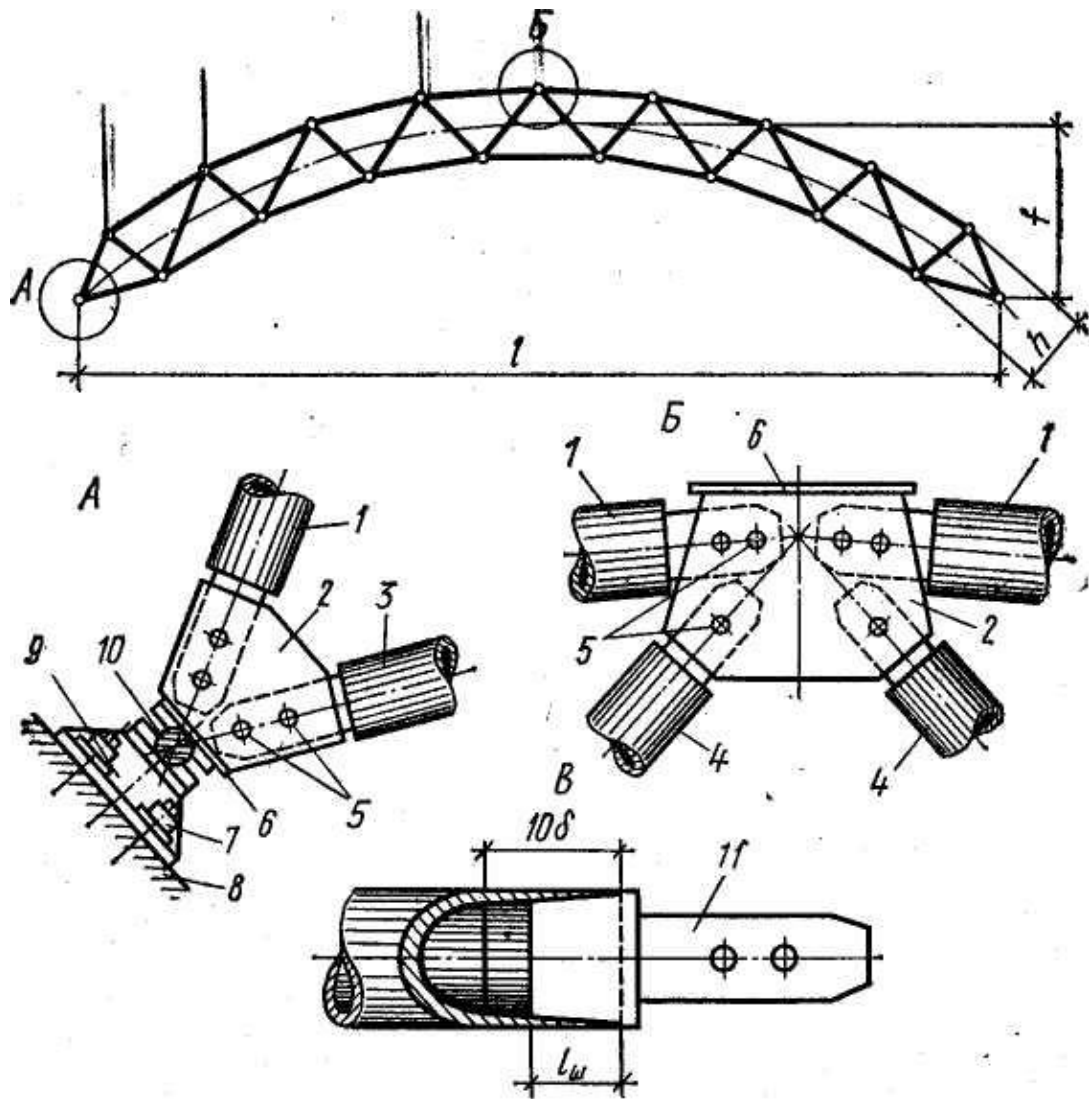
Двошарнірна наскрізна арка: А – опорний вузол; Б – проміжний вузол; І – деталь оголовка стрижня; 1, 3, 4 – стрижні; 2 – фасонка; 5 – болт кріплення стрижня у вузлі; 6 – сполучна планка; 7 – анкер; 8 – основа; 9 – опорна частина основи; 10 – опорний шарнір; 11 - пробка з випуском
